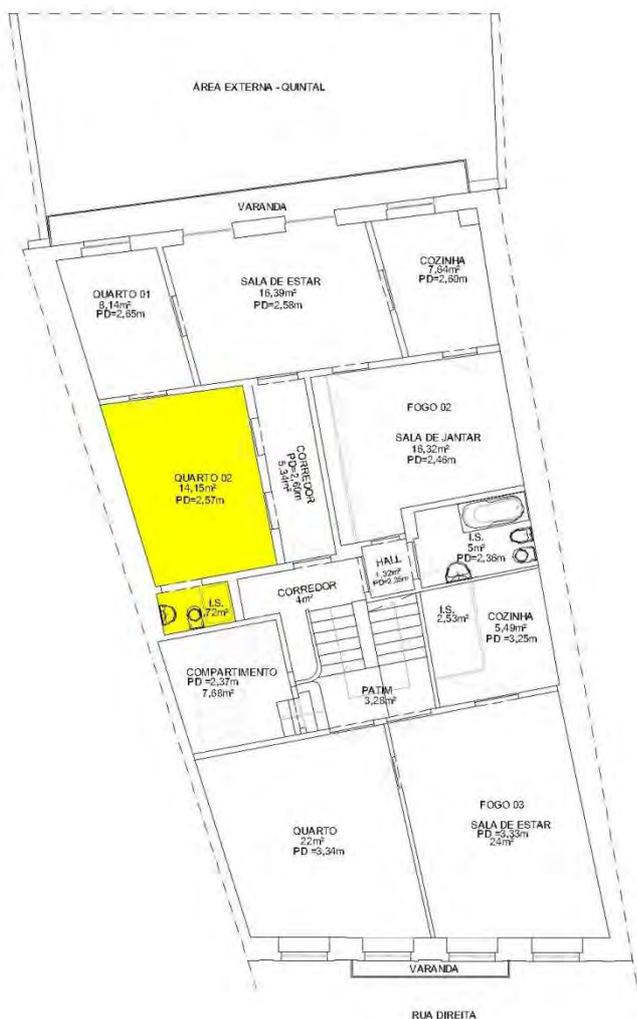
Planta do primeiro e segundo pavimento com destaque para o quarto 02 com suíte.
